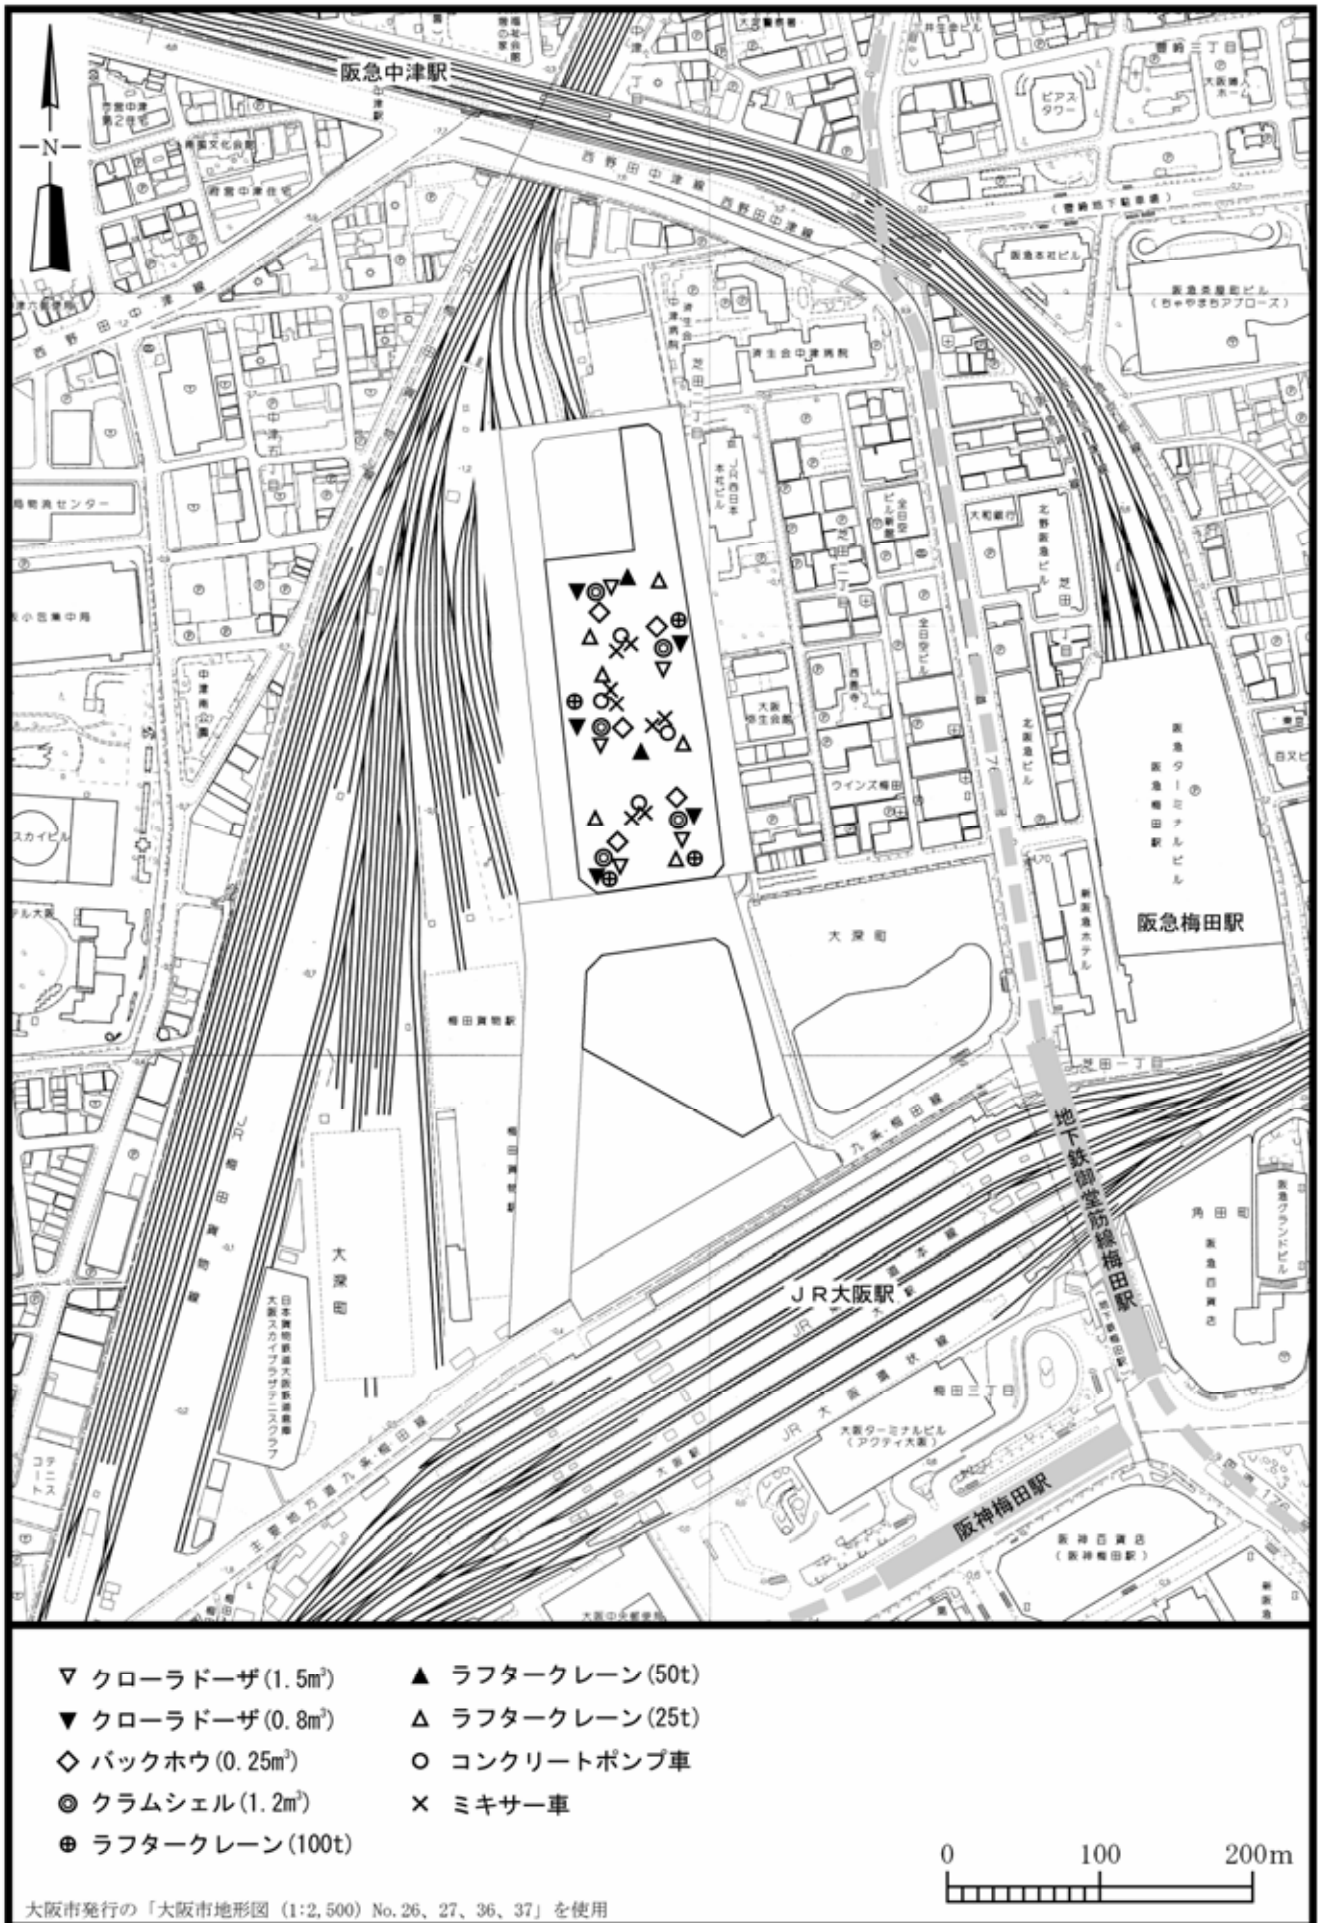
(2) 騒音源配置図 (B 地区工事最盛期)
